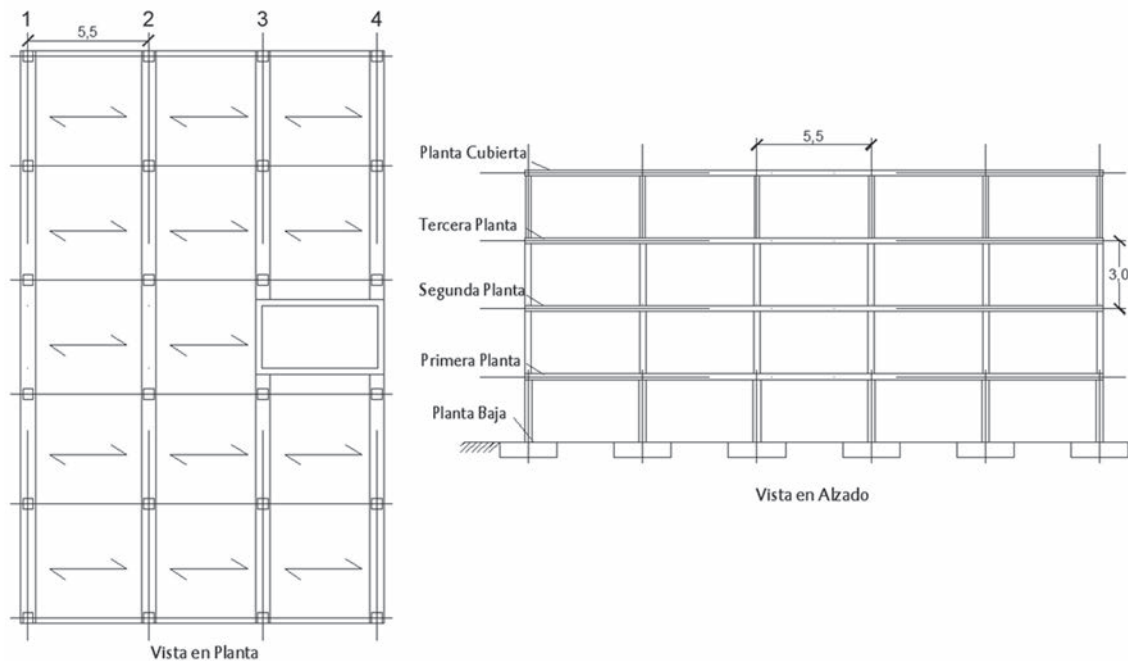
Planta tipo y alzado de uno de los pórticos del edificio.
